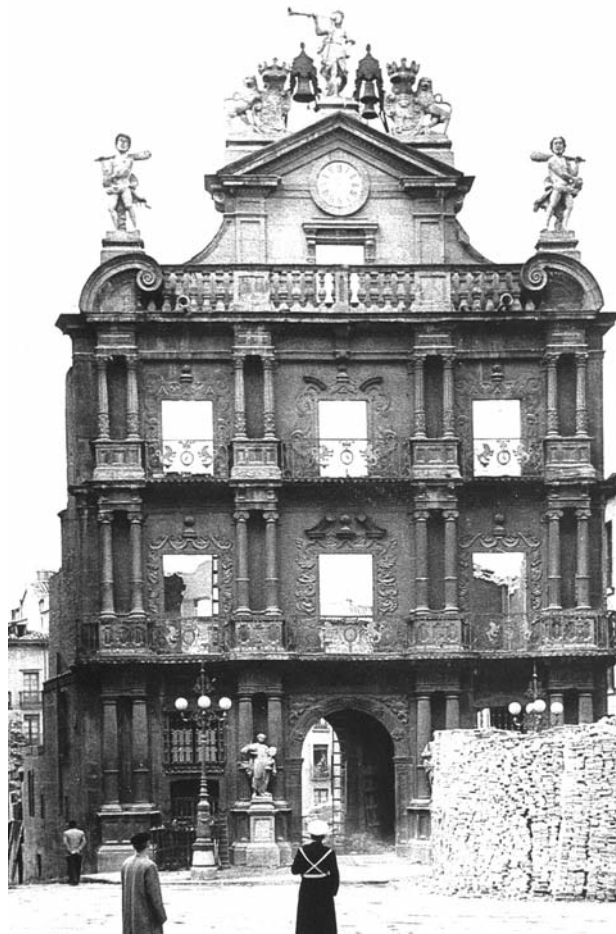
Fachada consistorial tras el derribo del edificio. Año 1952. AMP (Foto José Galle)
